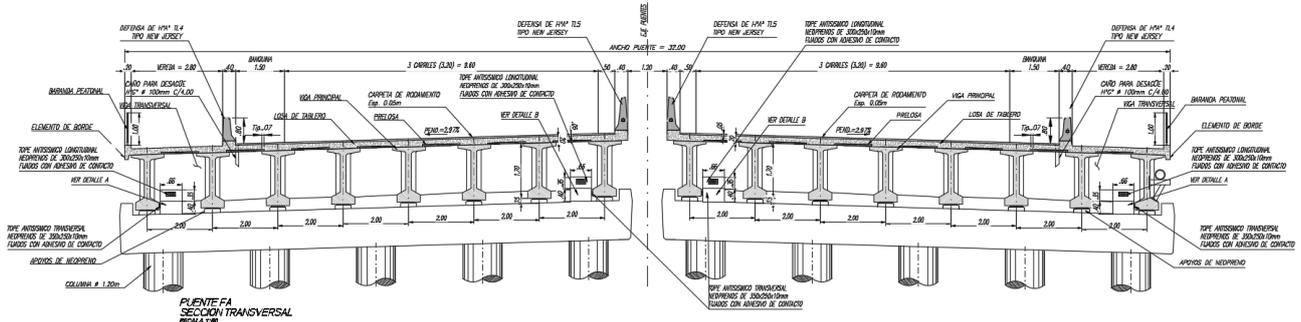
Sección transversal tablero Puente Av. Fuerza Aérea
